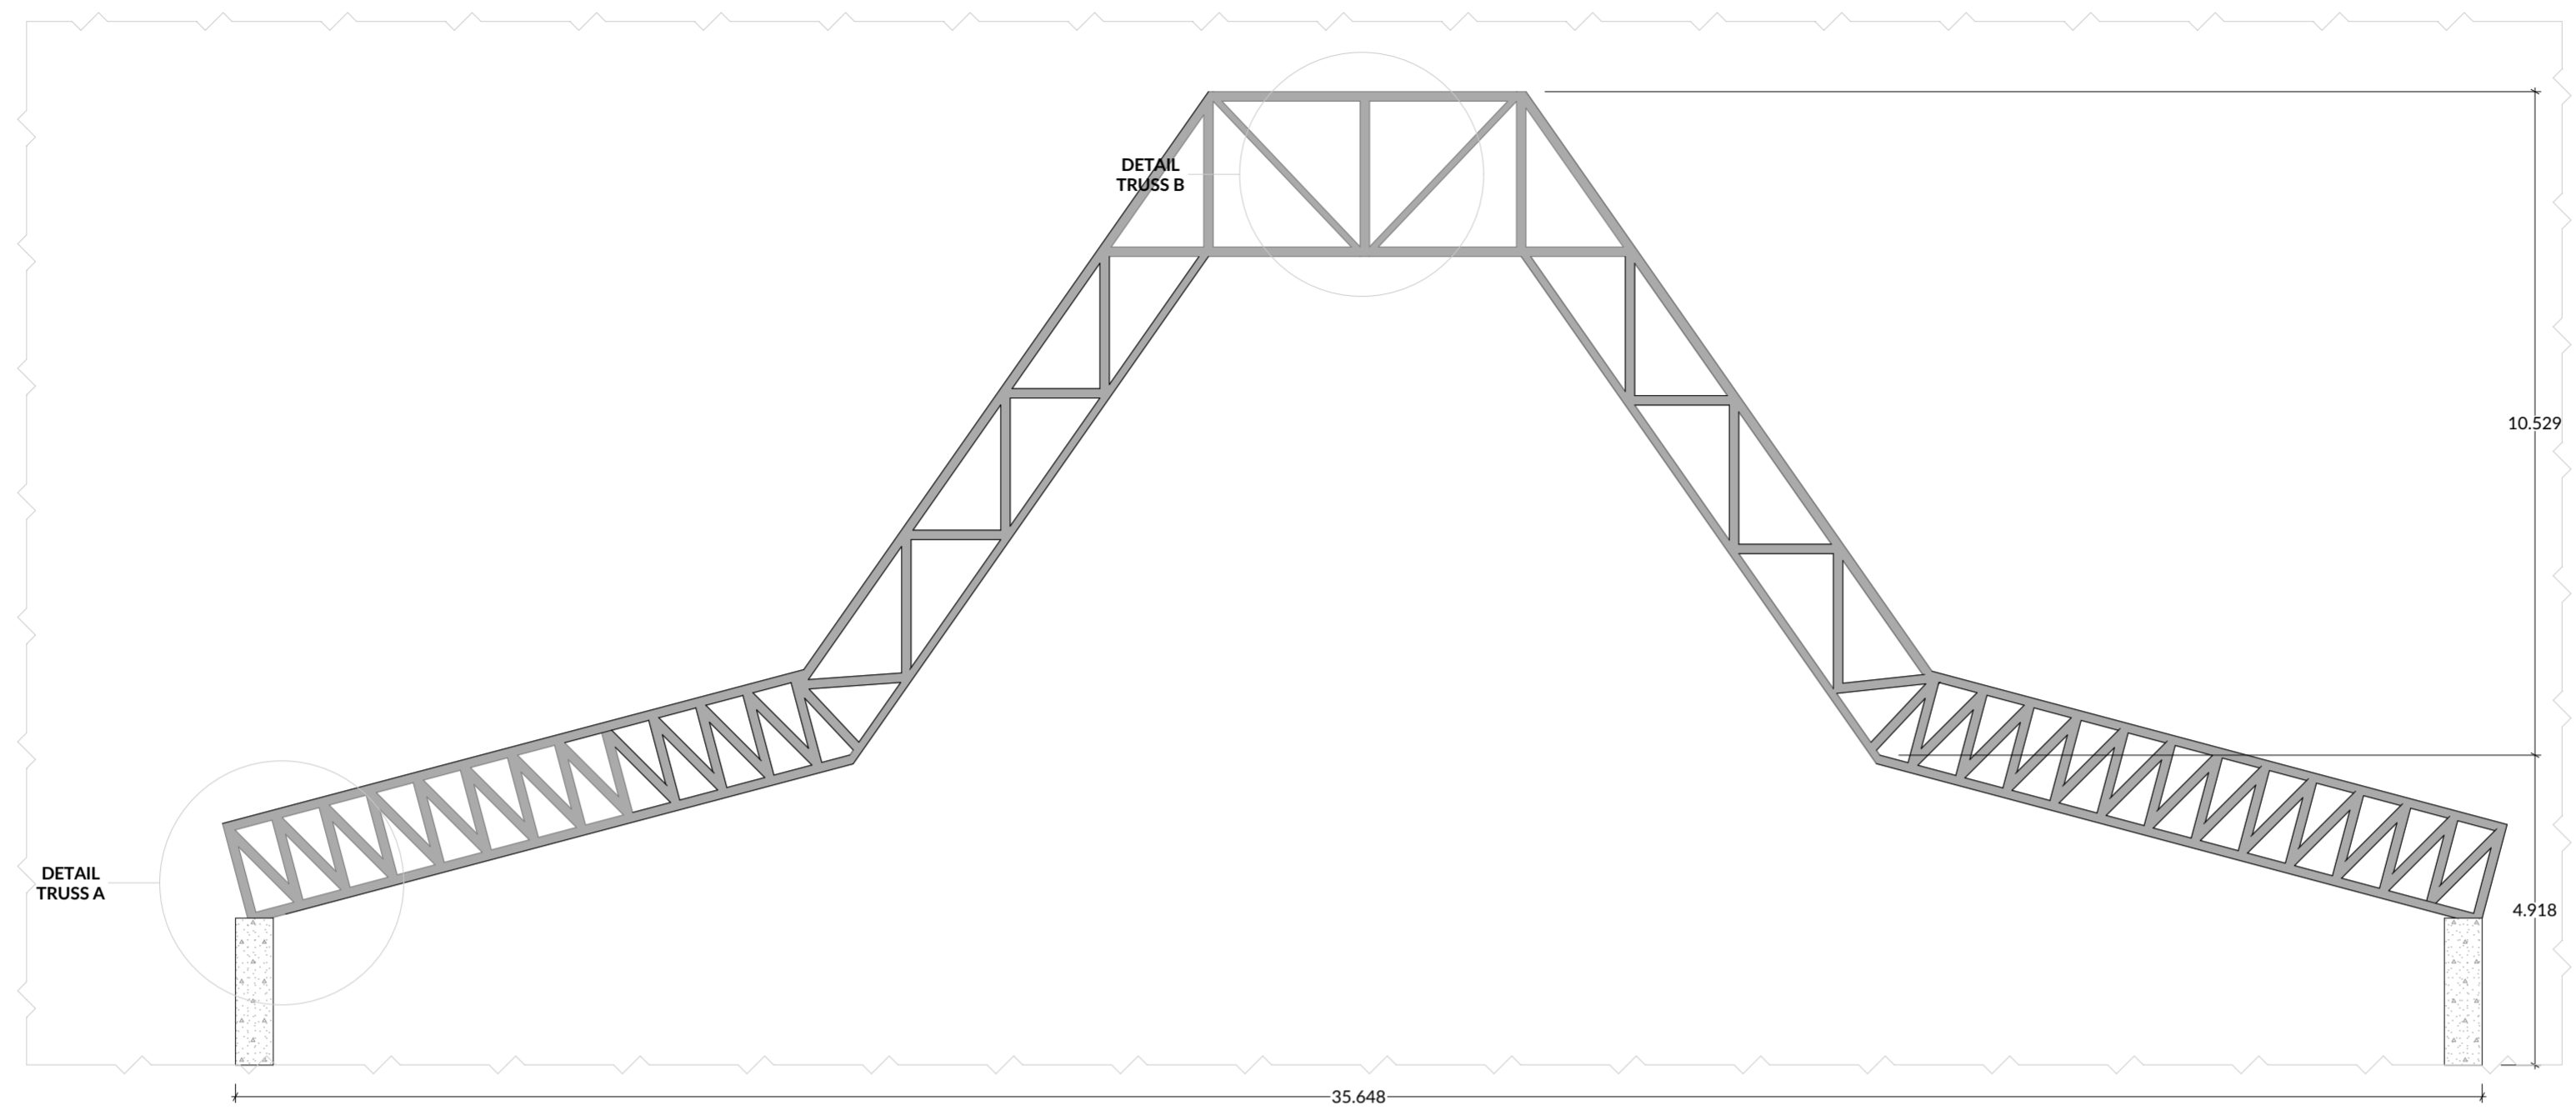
DETAIL TRUSS BAJA ENTRANCE, DETAIL TRUSS BAJA
